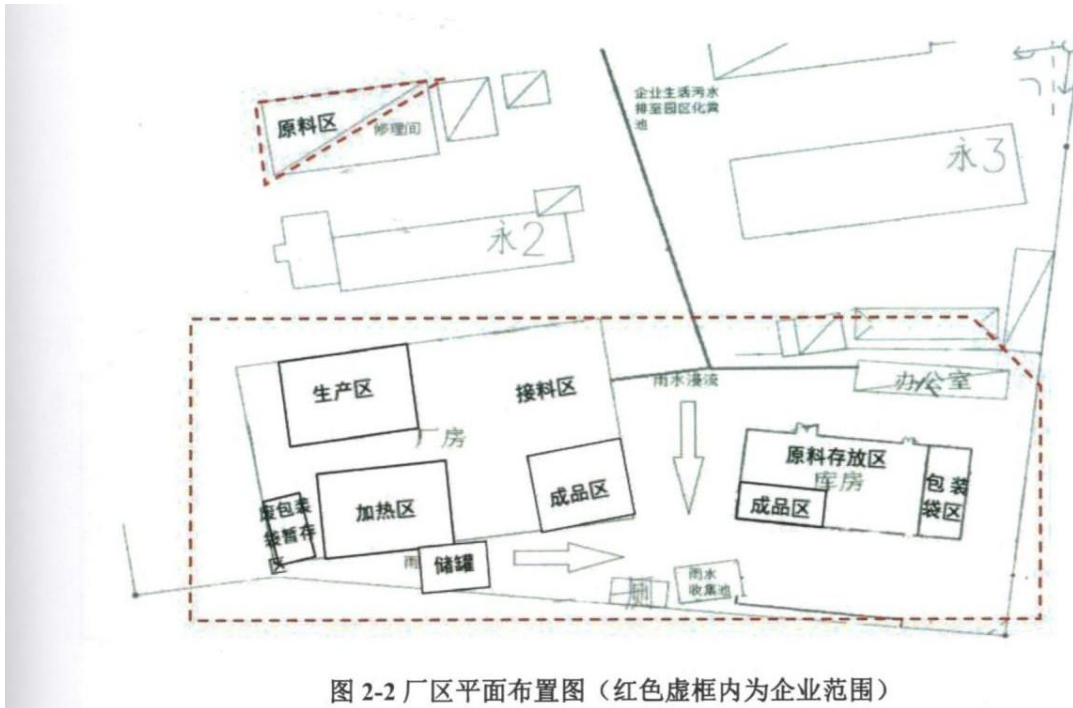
厂区平面布置图（红色虚框内为企业范围）
